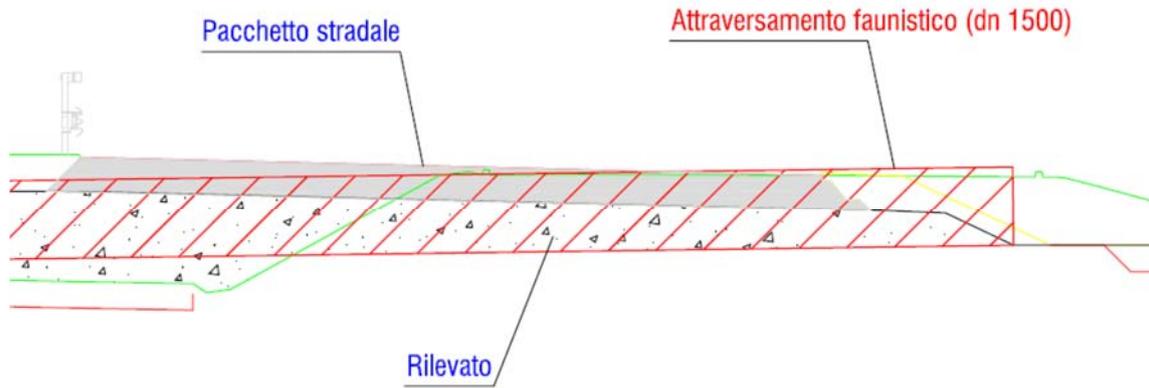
Stralcio della sezione alla progressiva 0+800. Il diametro appare evidentemente maggiore del rilevato, andando a coinvolgere anche la pavimentazione stradale
